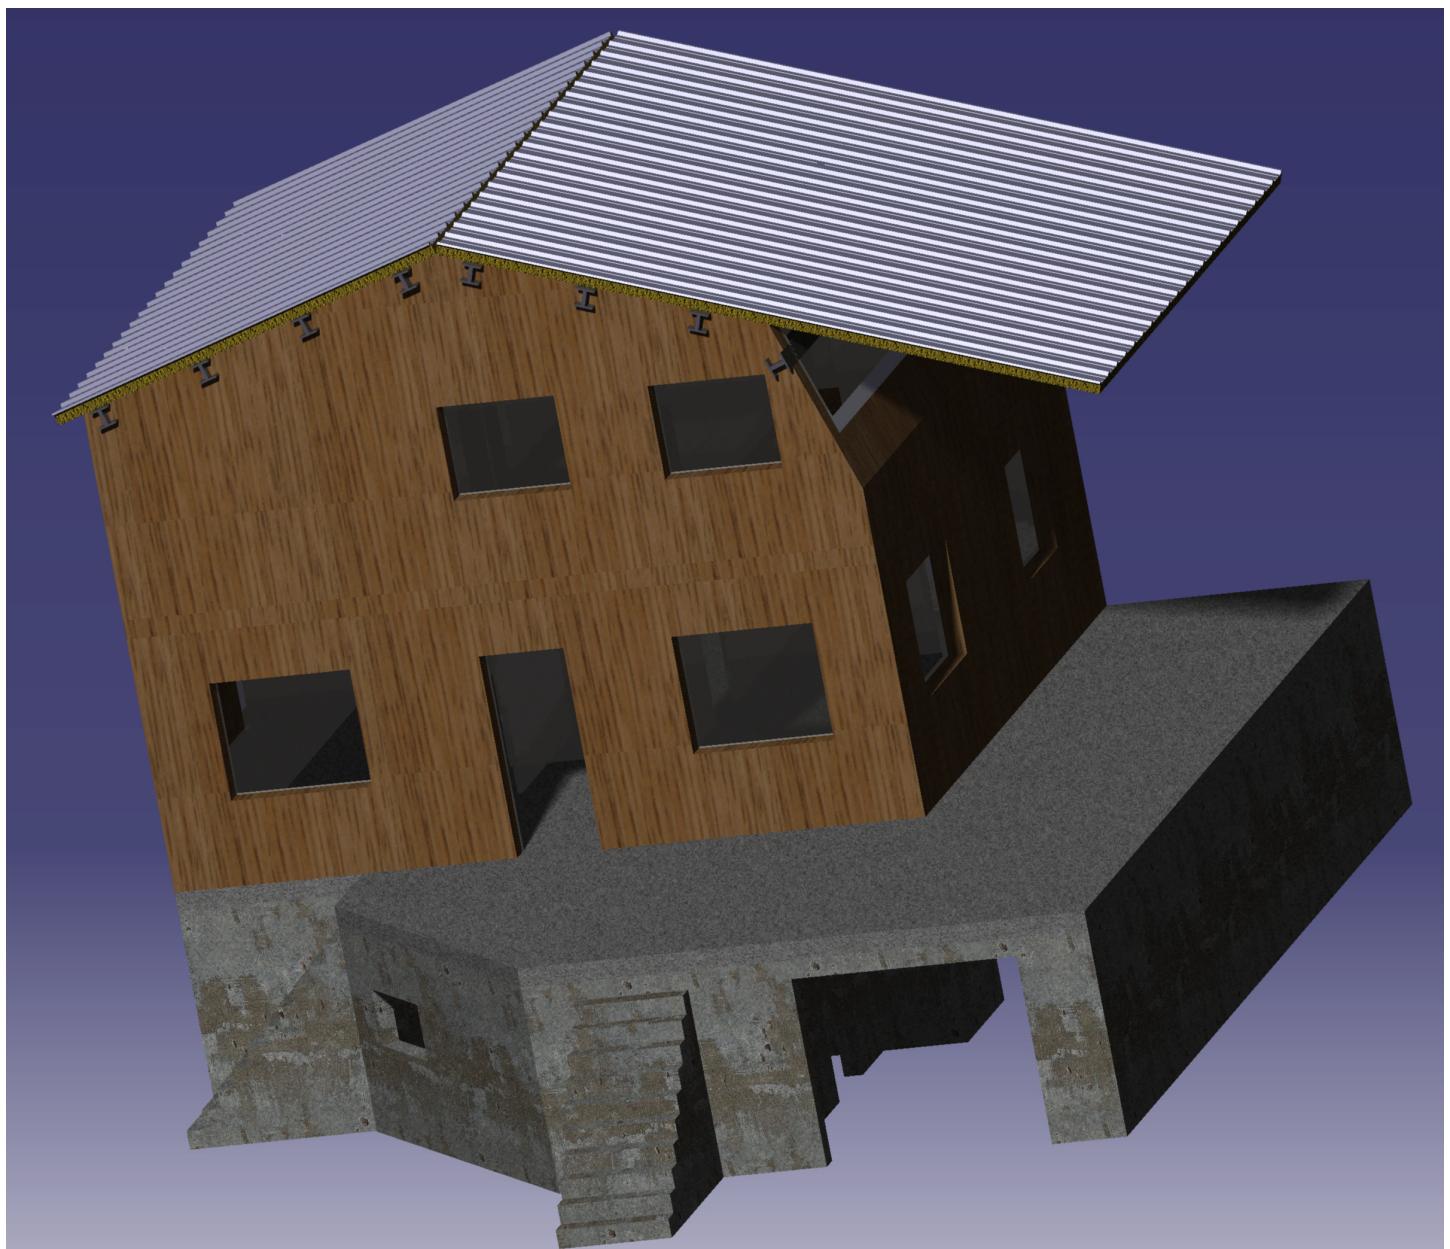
Après : isolation par l'extérieur (laine de verre/roche/bois? + bardage bois ou composite), couverture en tôle acier (cheminée, ventilation non dessinées). Débord de toit facultatif mais souhaitable (complément de charpente ou poteaux de soutien non représentés)
